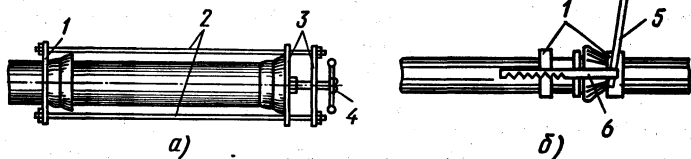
Монтажные приспособления для заделки труб с резиновым кольцом:
